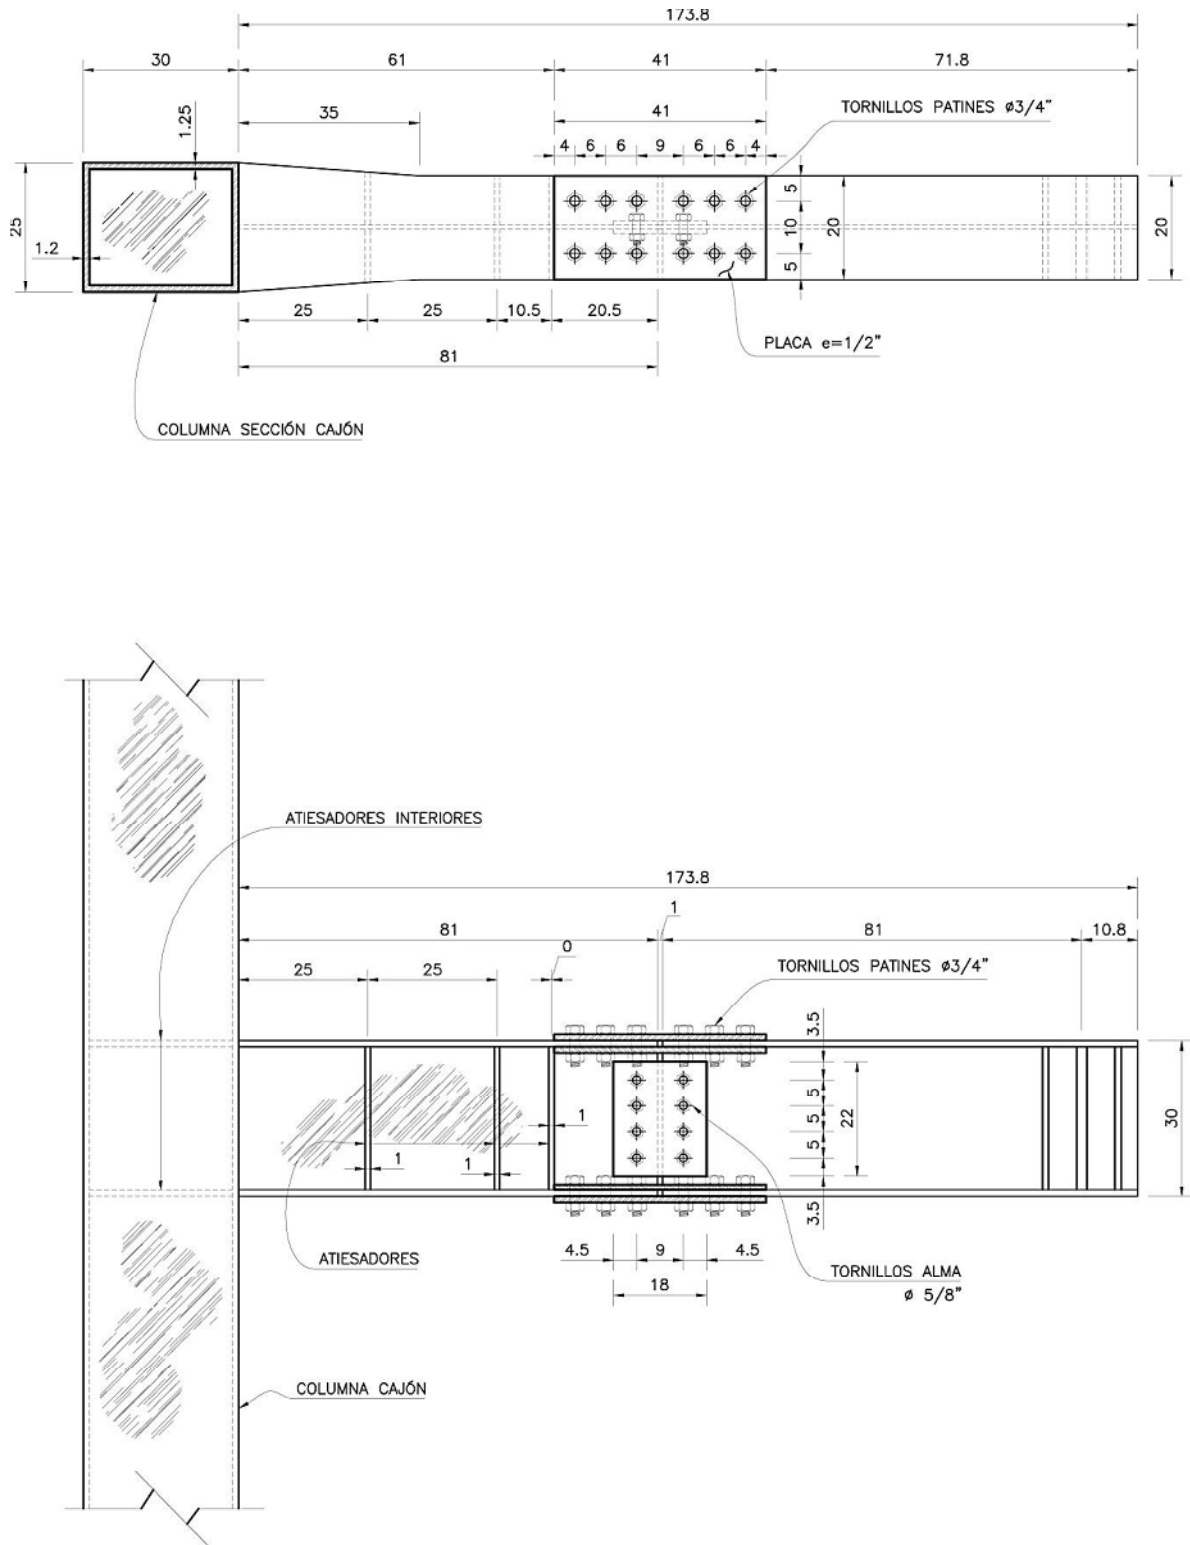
Conexión BFP6, en la parte superior vista en elevación y en la inferior la planta
